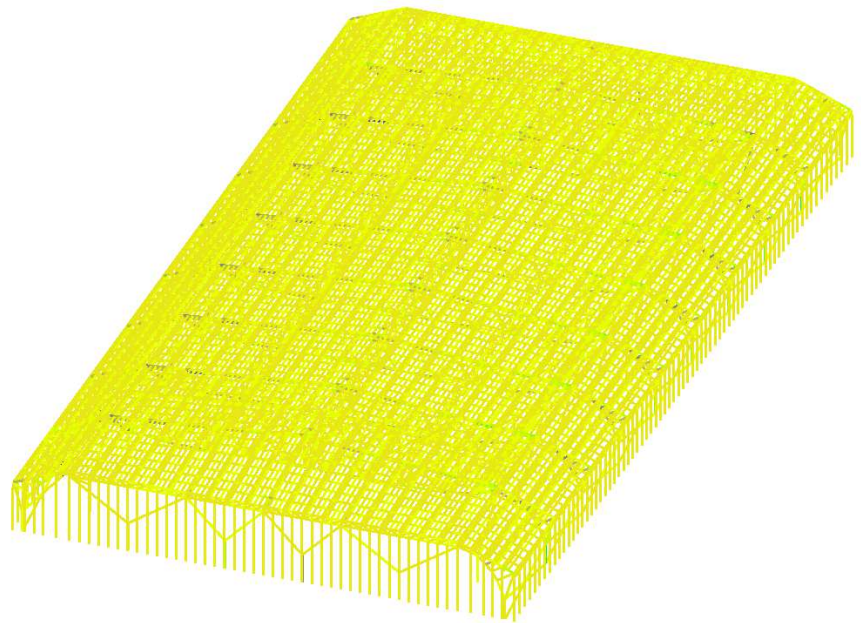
Поперечные силы, возникающие в элементах каркаса без консолей при расчете на основные нагрузки без учета снеговой и ветровой нагрузок
